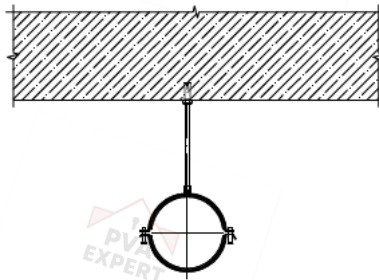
Узел крепления круглого воздуховода к перекрытию
